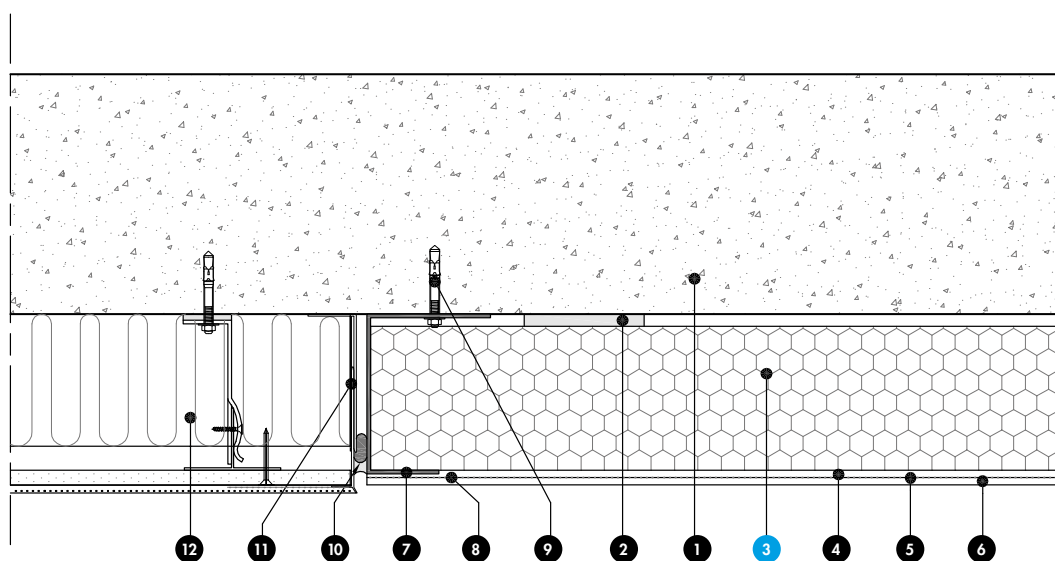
Raccordement avec d'autres systèmes d'isolation (coupe horizontale)
